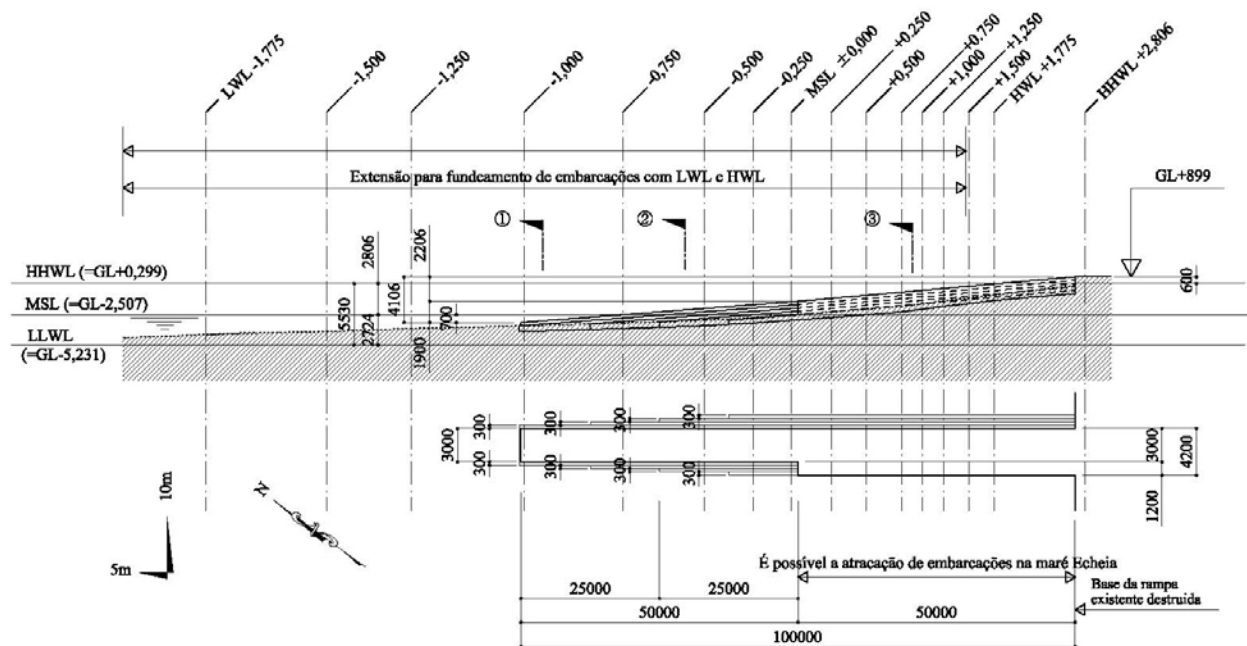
Plano Bidimensional e Longitudinal da Via de Acesso
